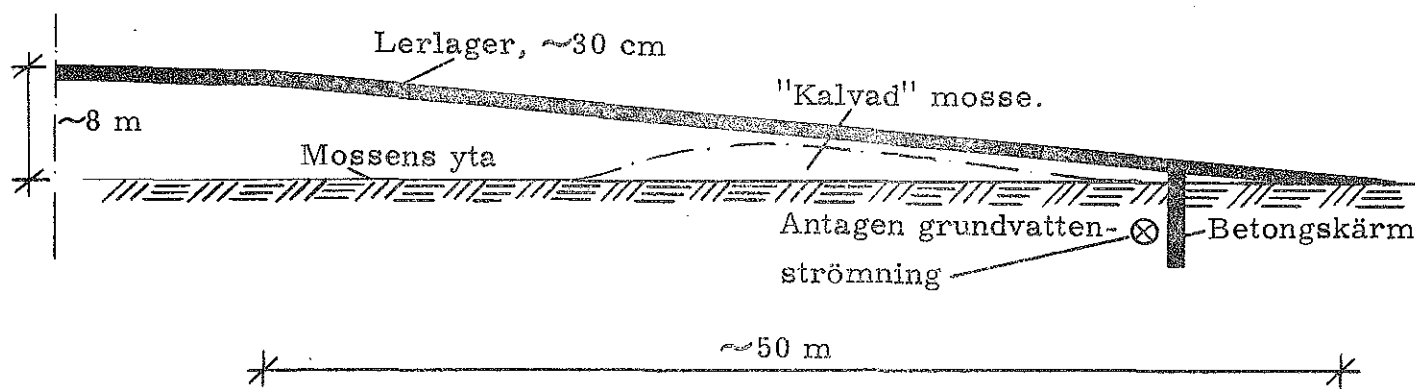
(Snitt B-B, bil 10.2). Betongskärm (ledskärm)
